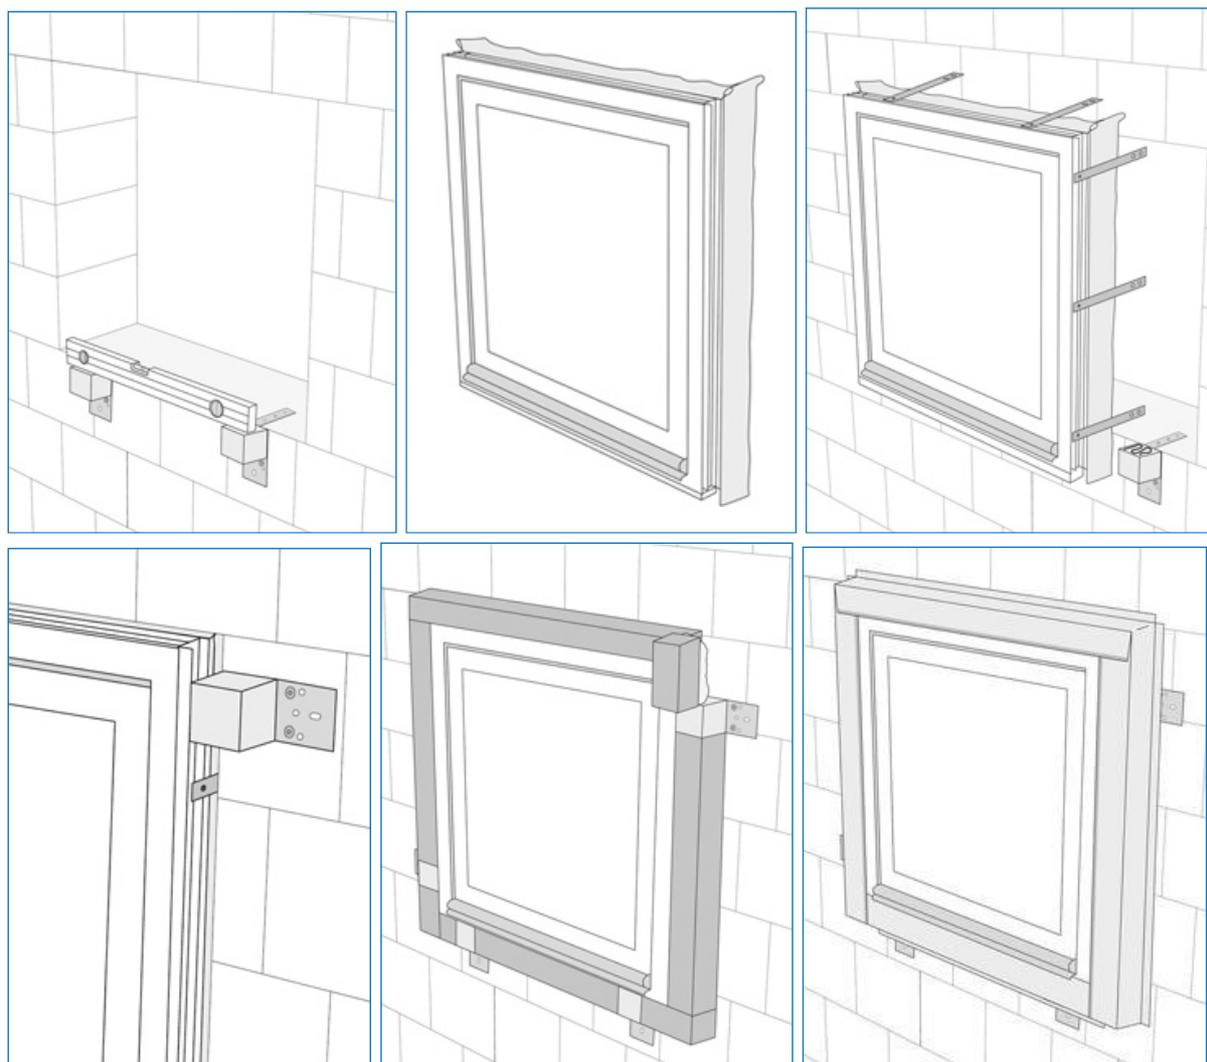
Fasi di installazione delle finestre nello strato di isolamento termico
